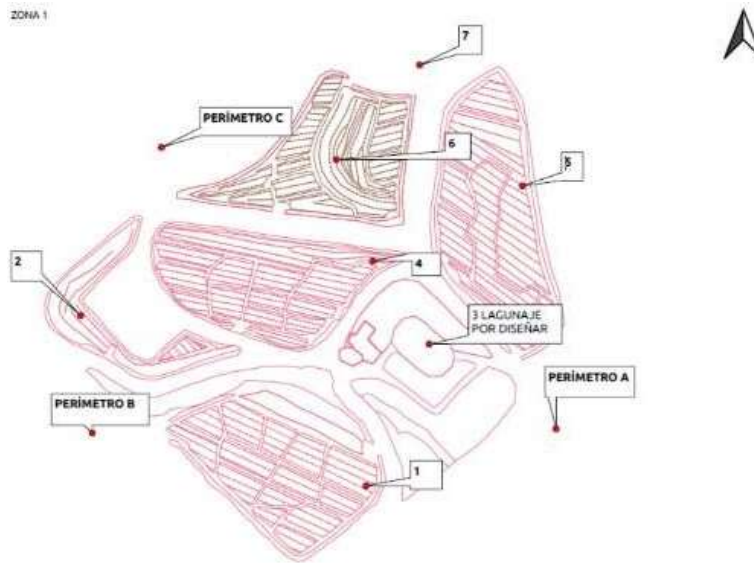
Plano Zona 1 Parque Central. Fuente: Ayuntamiento de Adeje
